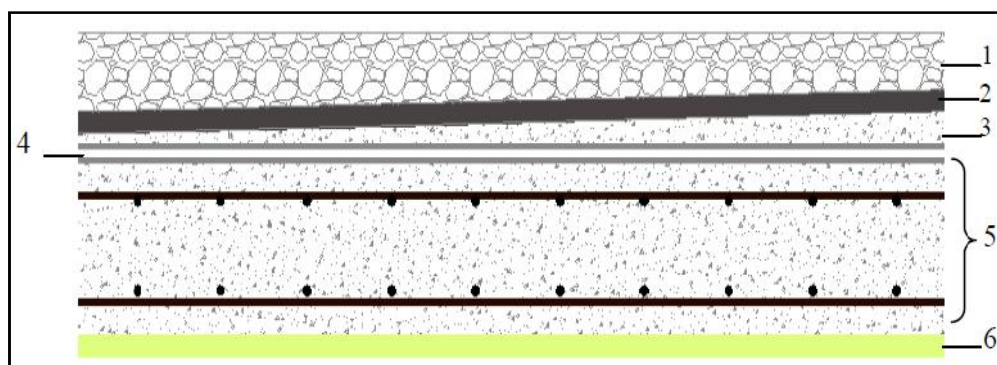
Composants d'un plancher terrasse en dalle pleine.
